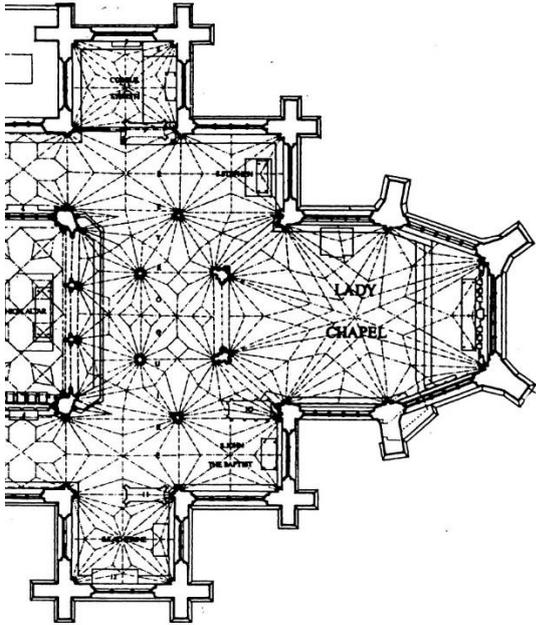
Wells, Kathedrale, Grundriss von Retrochor und Marienkapelle
